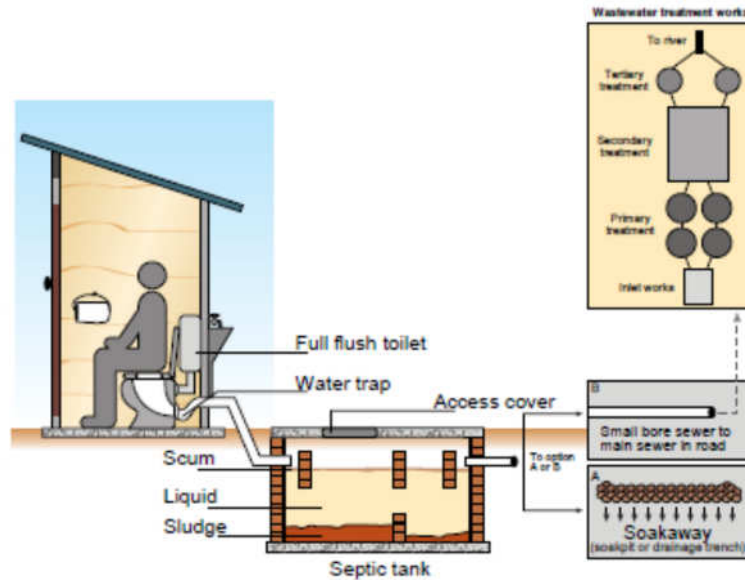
Perpipaan air limbah dangkal (*shallow sewer*)
